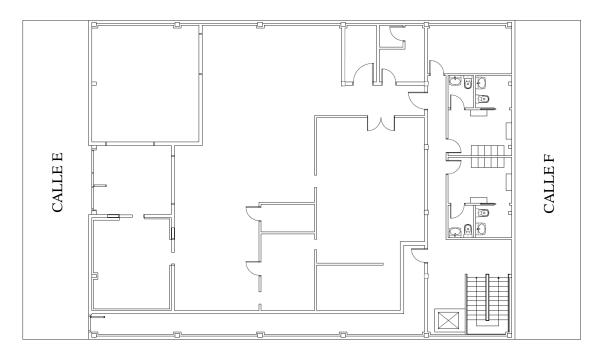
Zona trabajadores con equipamiento. Fuente; Elaboración propia.
